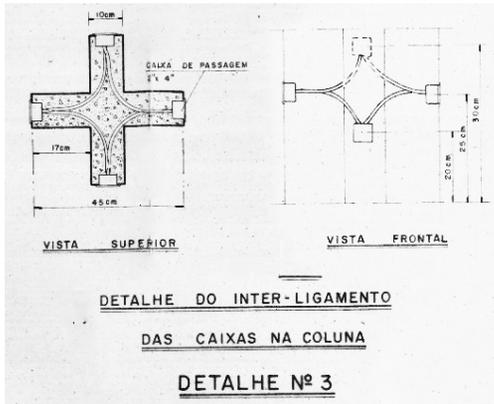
Detalhe, Caixa no pilar em “Cruz”
